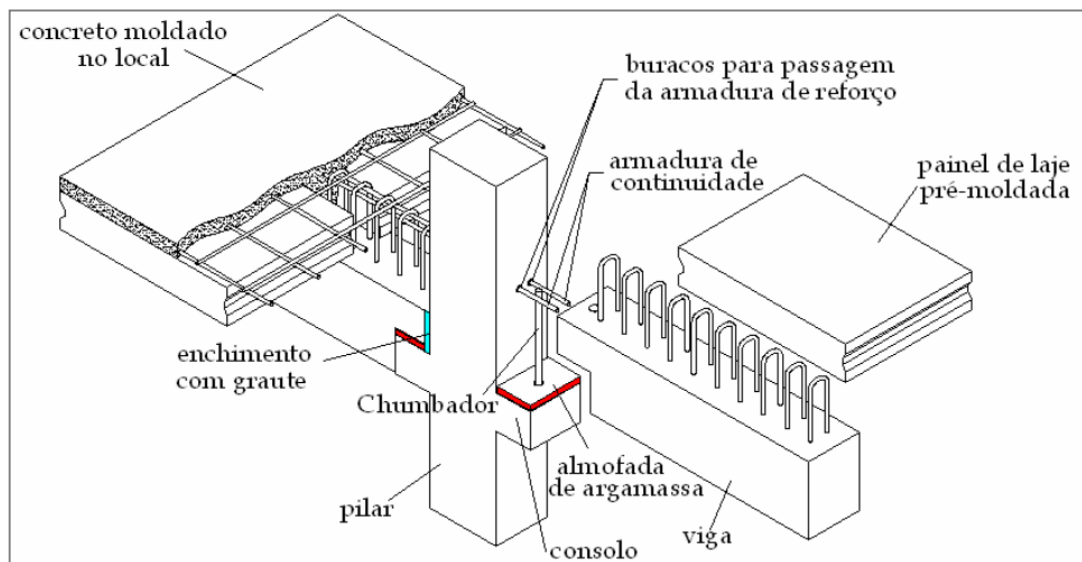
Esquema de ligação viga-pilar (SIQUEIRA, 2007)
